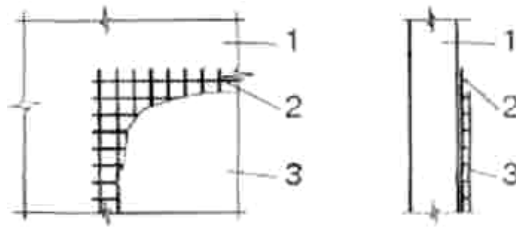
Схема підсилення залізобетонної стінки армованим полімербетоном:
